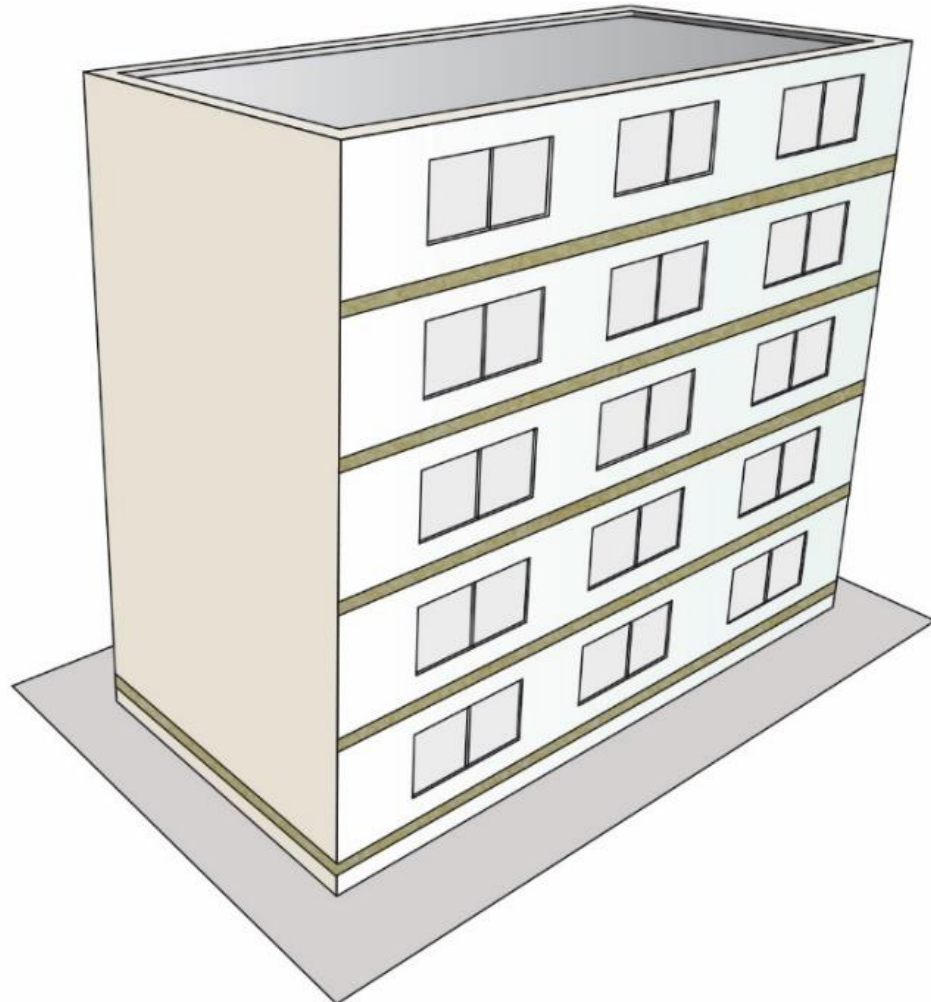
Disposition des bandes filantes sur des façades aveugles : cas d'un système avec enduit hydraulique épais
